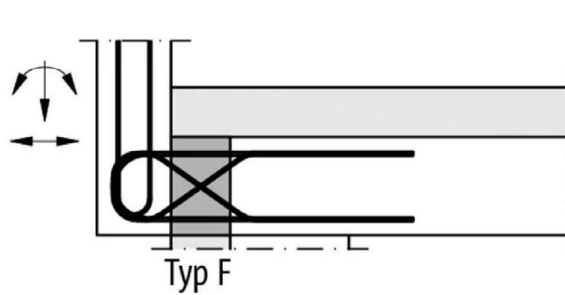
Schöck Isokorb® Typ F für vorgesetzte Brüstungen
